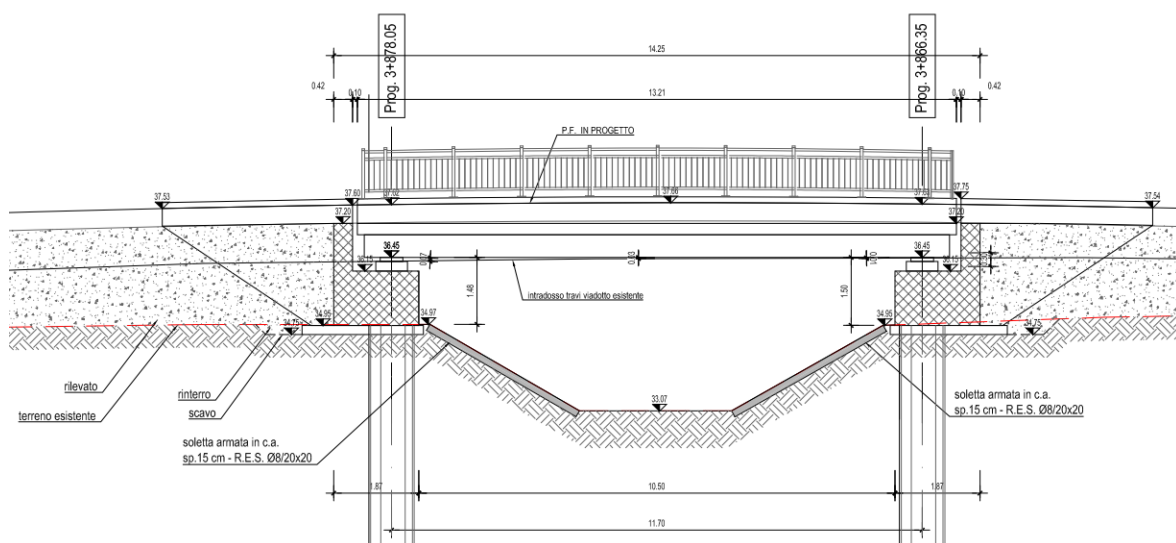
PROSPETTO DEL PONTE IN PROGETTO SUL FOSSO DEL PRUNAIA
